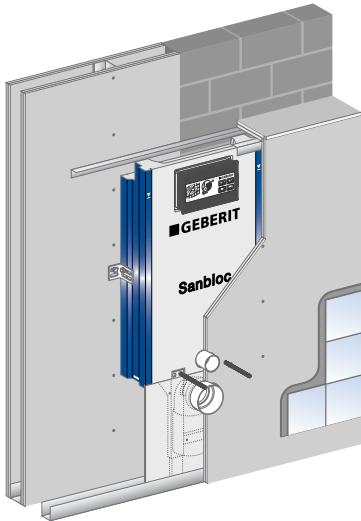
Vorwandinstallation in Trockenbauweise vor einer nass gemauerten Wand oder Trockenbauwand
